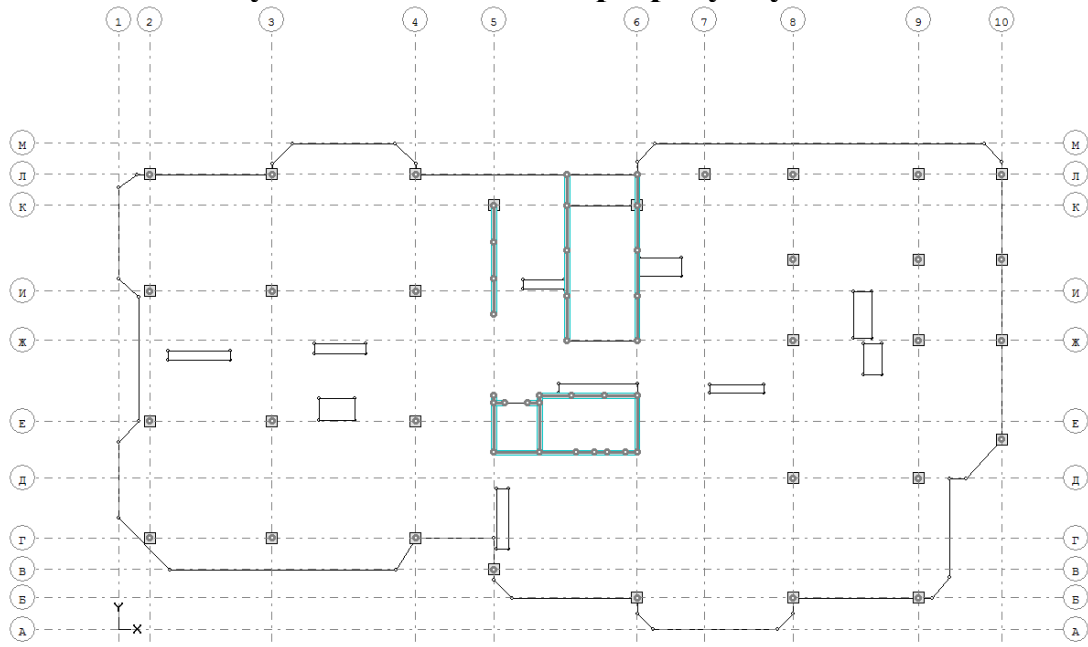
Опалубочне креслення плити перекриття типового поверху
